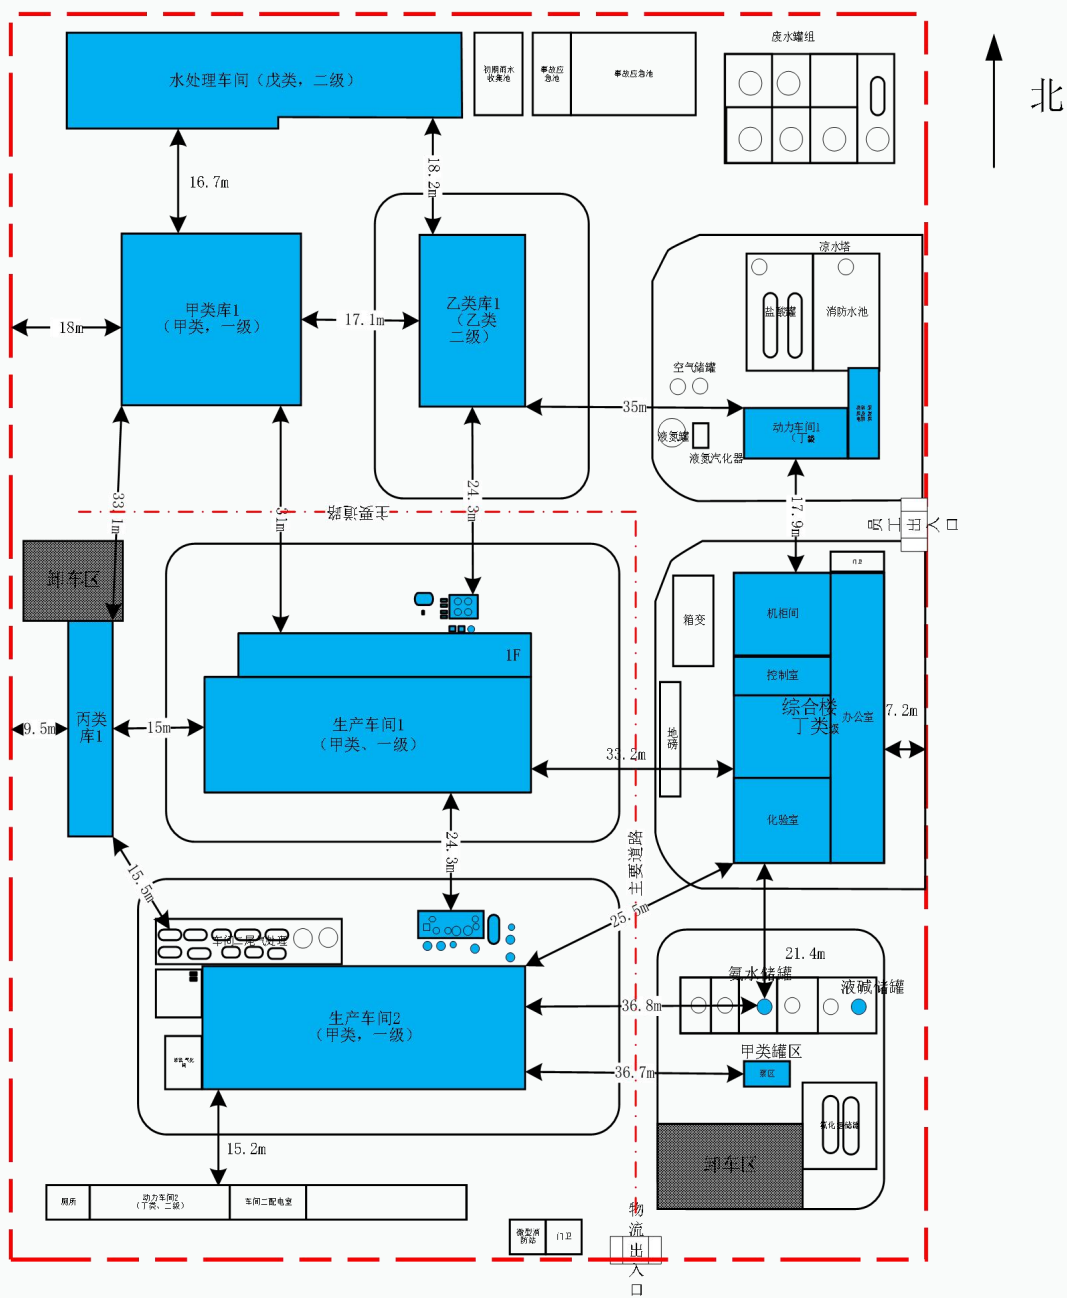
厂区总平面布置示意图 (蓝色部分为本次评价内容)
